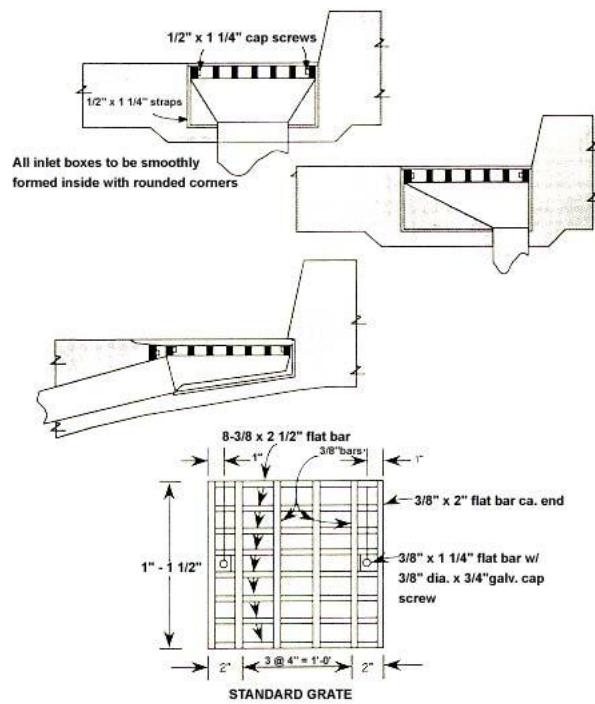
Einlauffassen aus Beton, Figure 2 in [23]
